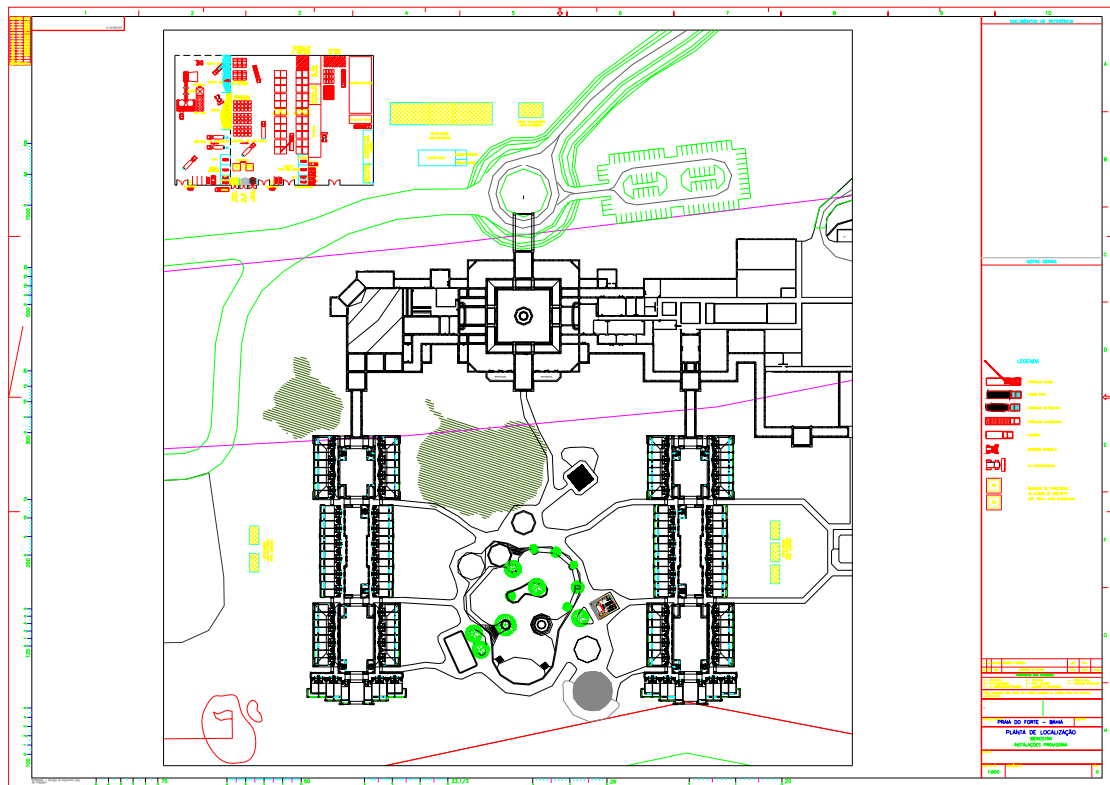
Planta Baixa do Complexo Iberostar Praia do Forte
